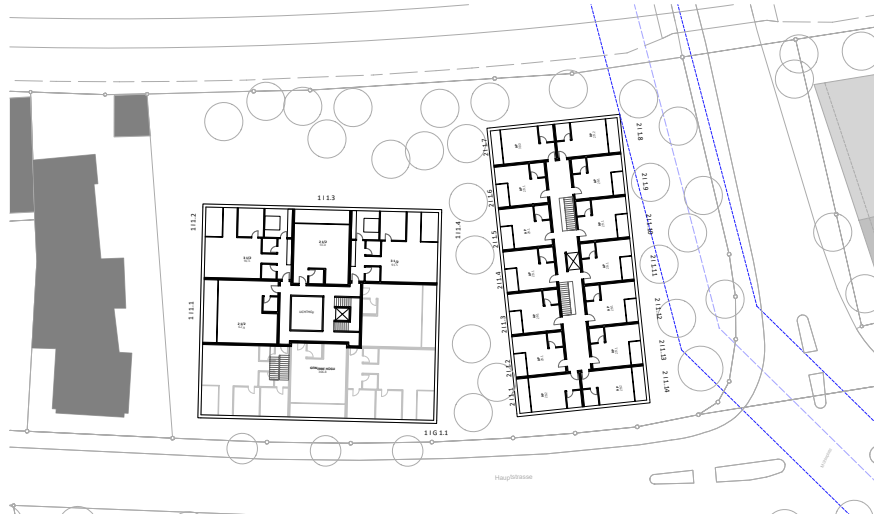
Grundrisse 1. Obergeschoss (Quelle: SDM - ARCHITEKT, November 2022)
